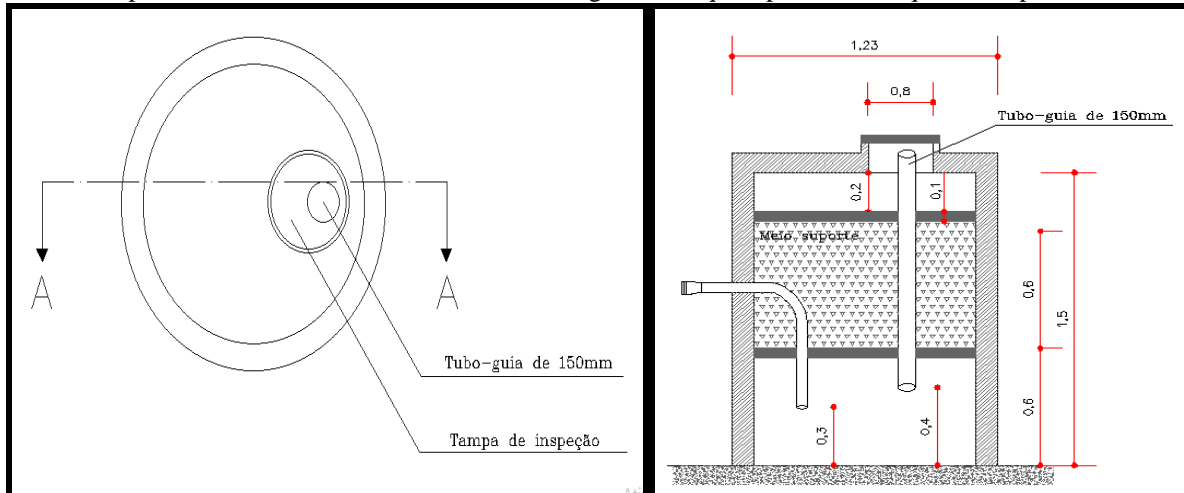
Planta baixa e corte lateral do Filtro Anaeróbio.
